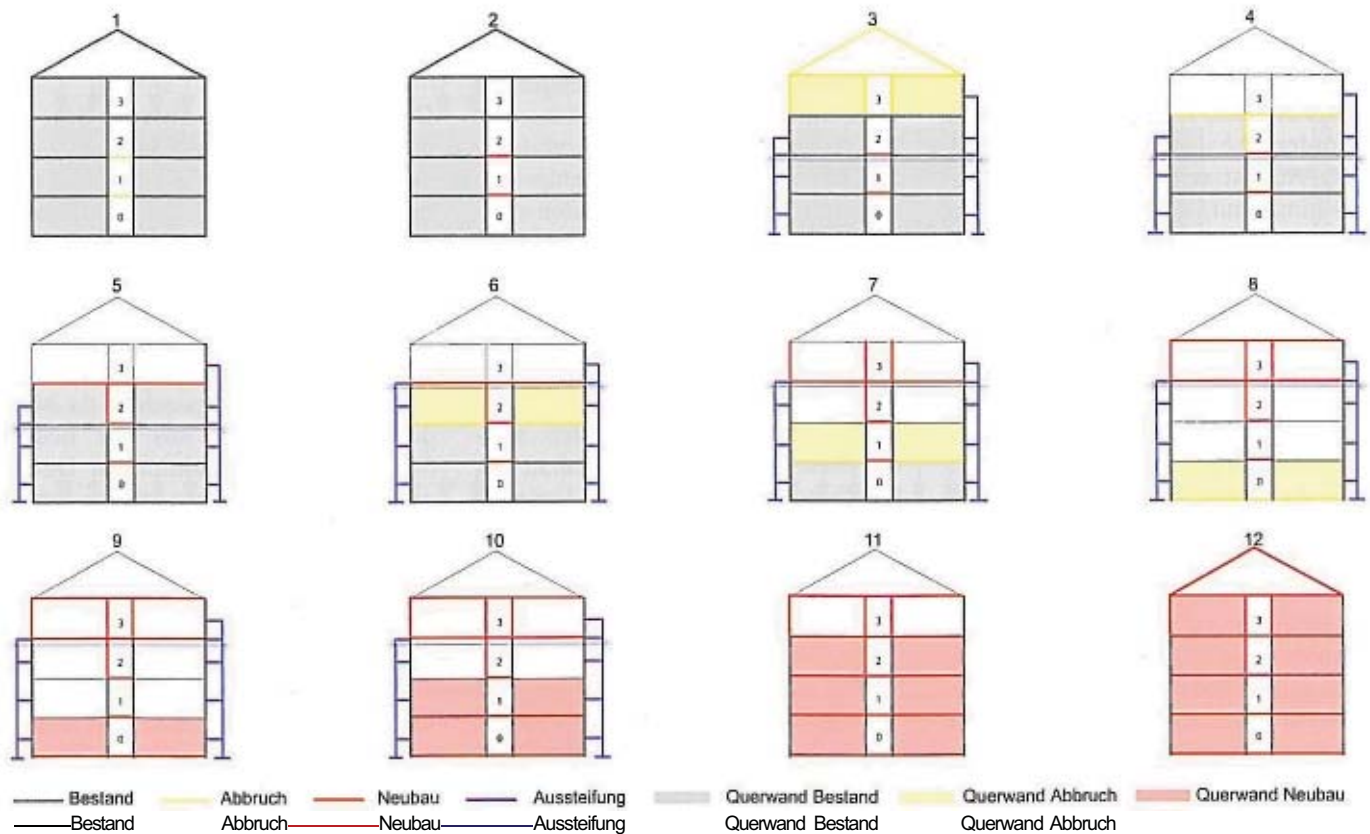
Skizzenhafte Darstellung der Ausführungsreihenfolge beim Austausch der Geschossdecken und tragenden Querwände (Marktgebäude Dampfschiff)
